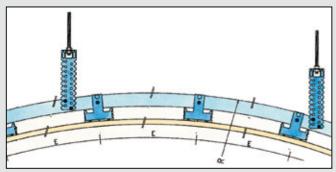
Plafond courbe avec profilés CD 60 concaves et suspentes U
